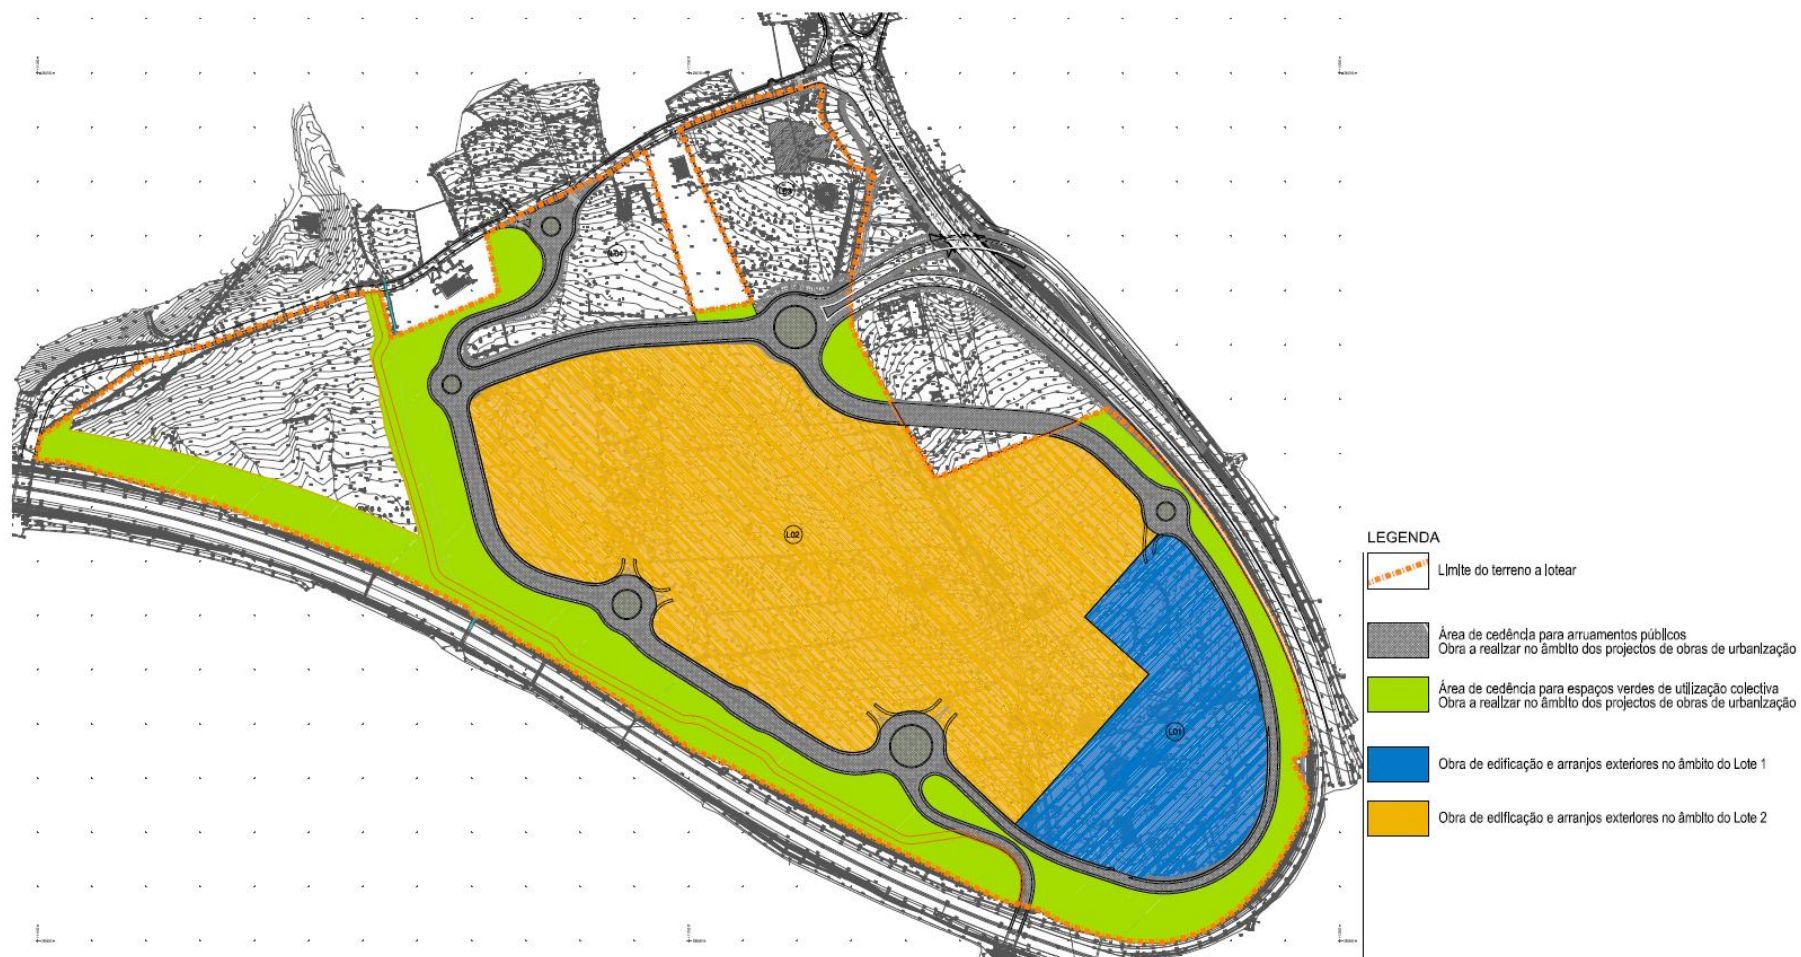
Obras de urbanização e obras de edificação e arranjos exteriores no âmbito dos lotes 1 e 2
